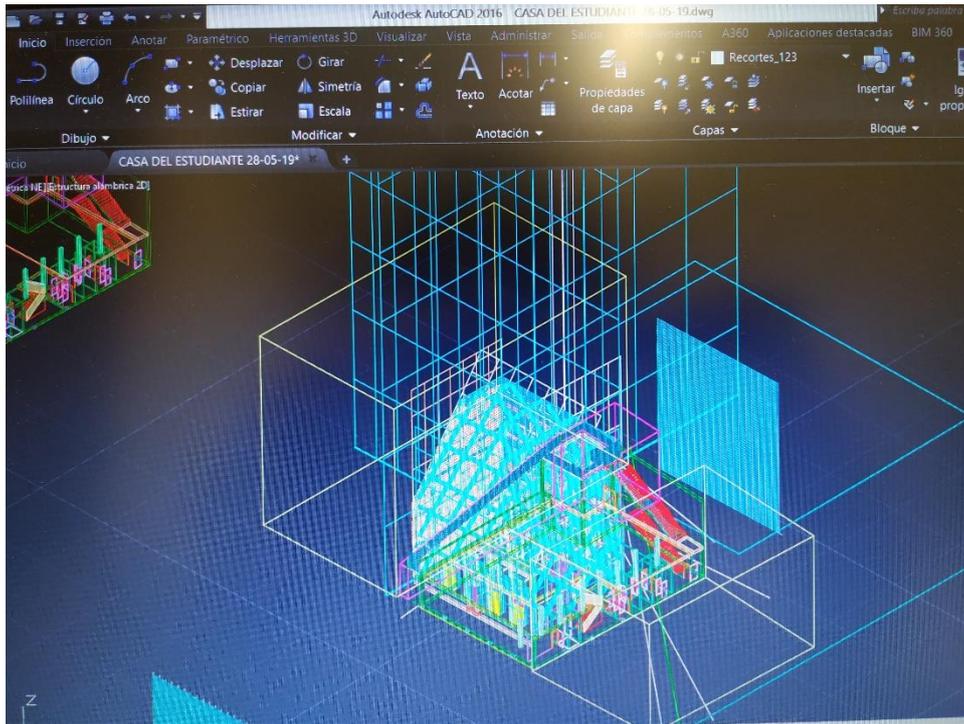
Modelado AutoCAD - Perfiles metálicos. Casa del Estudiante
